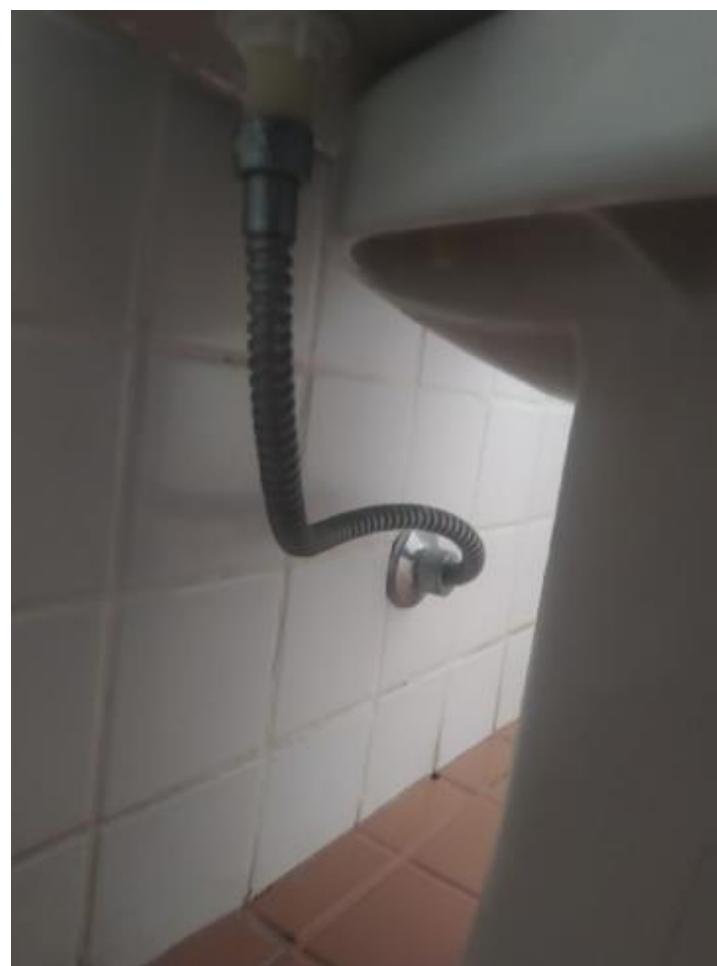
Visão detalhada Cabine 01 - Tubo de ligação vaso sanitário/parede
